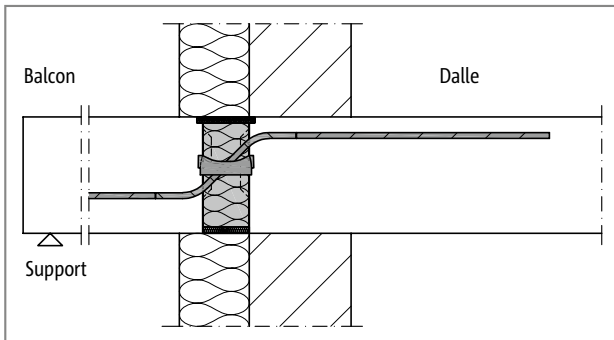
Schöck Isokorb® T Type Q-E : Raccordement pour isolation externe
